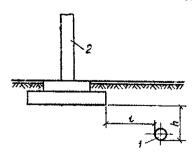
Прокладка подземной водосточной сети вдоль колони 1 — водосточная труба, 2 — колонна
